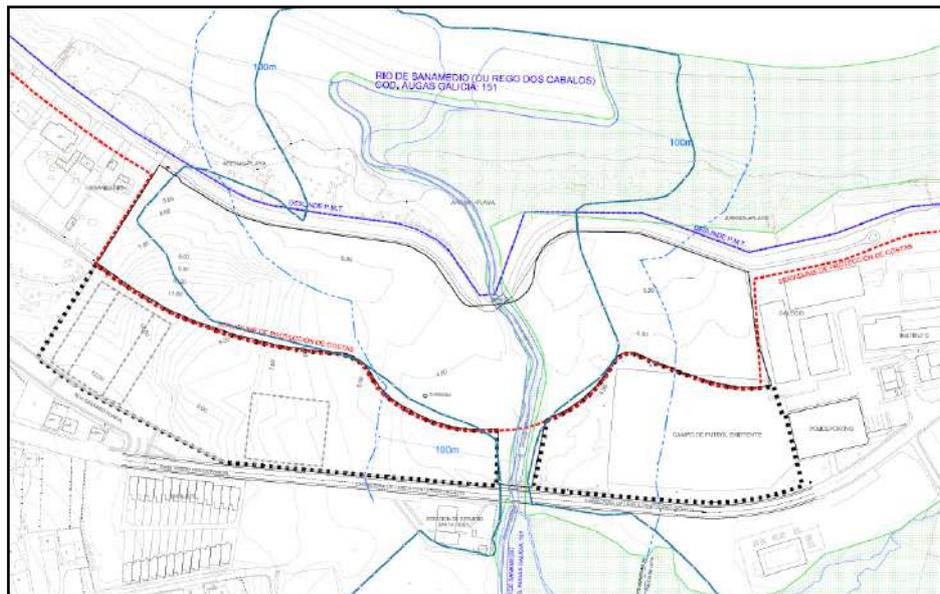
Traslado del límite del Area de Conservación a la planimetría del plan parcial.
